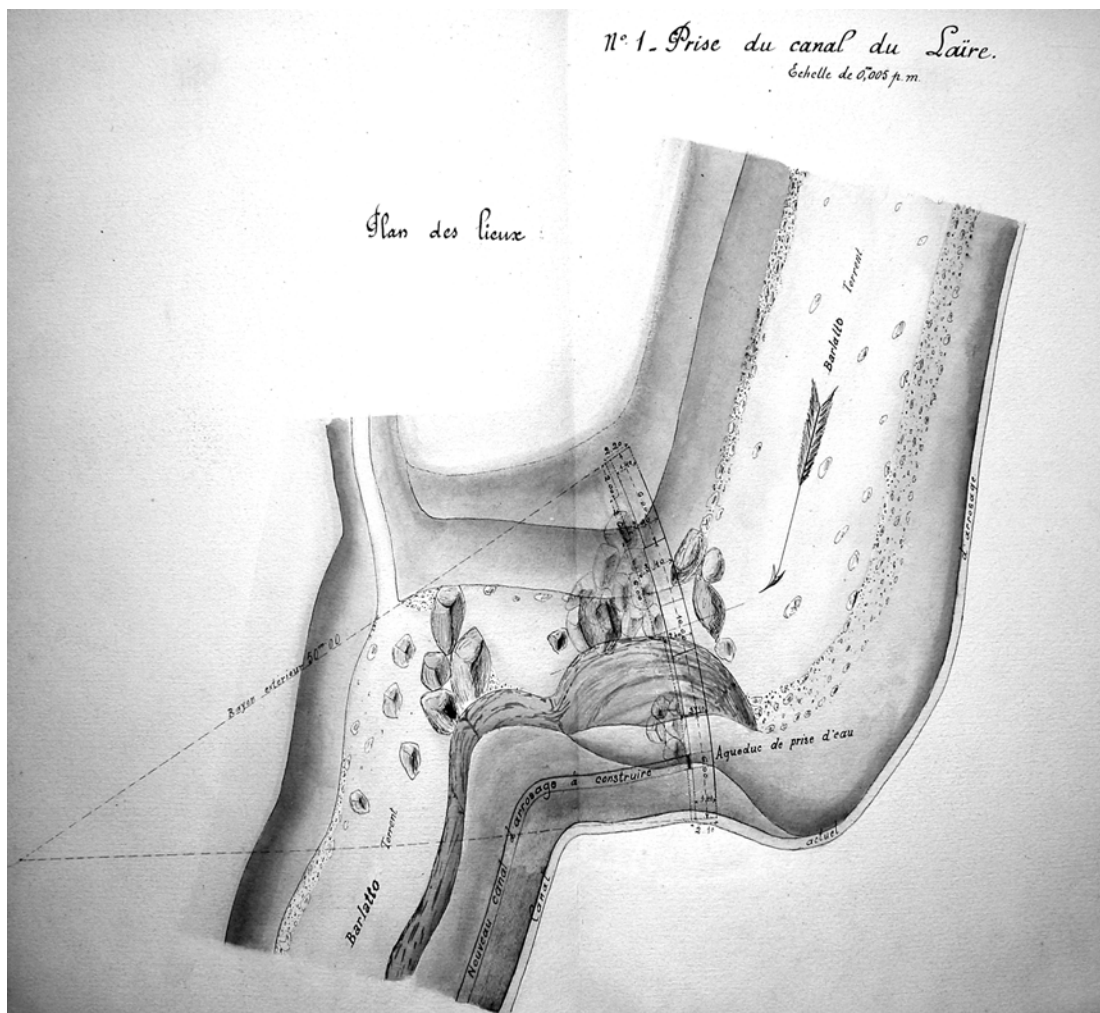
Plan du barrage de prise d'eau du canal du Laire. Dessin Eugène Ravel, 15 février 1897. (ADAM/7M521)
